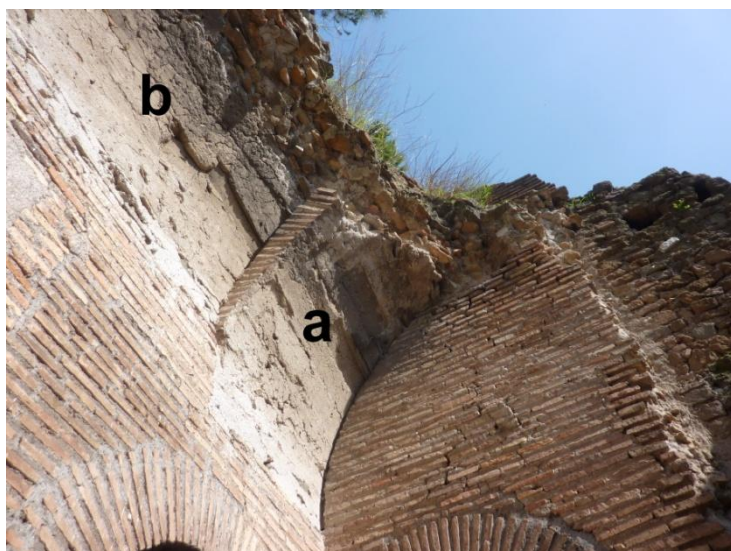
Torre K12, particolare dell'imposta delle coperture della camera del primo piano. Foto D'Ippolito.
